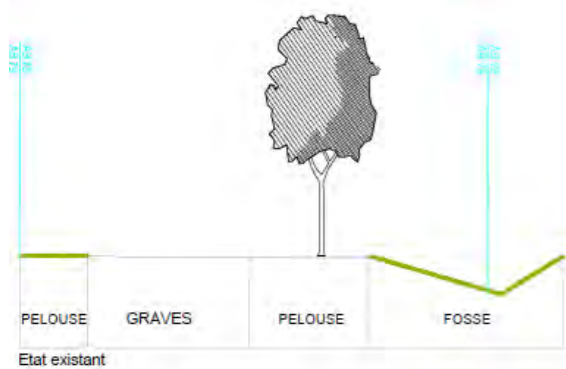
Profil en travers de l'existant – Coupe JJ'
